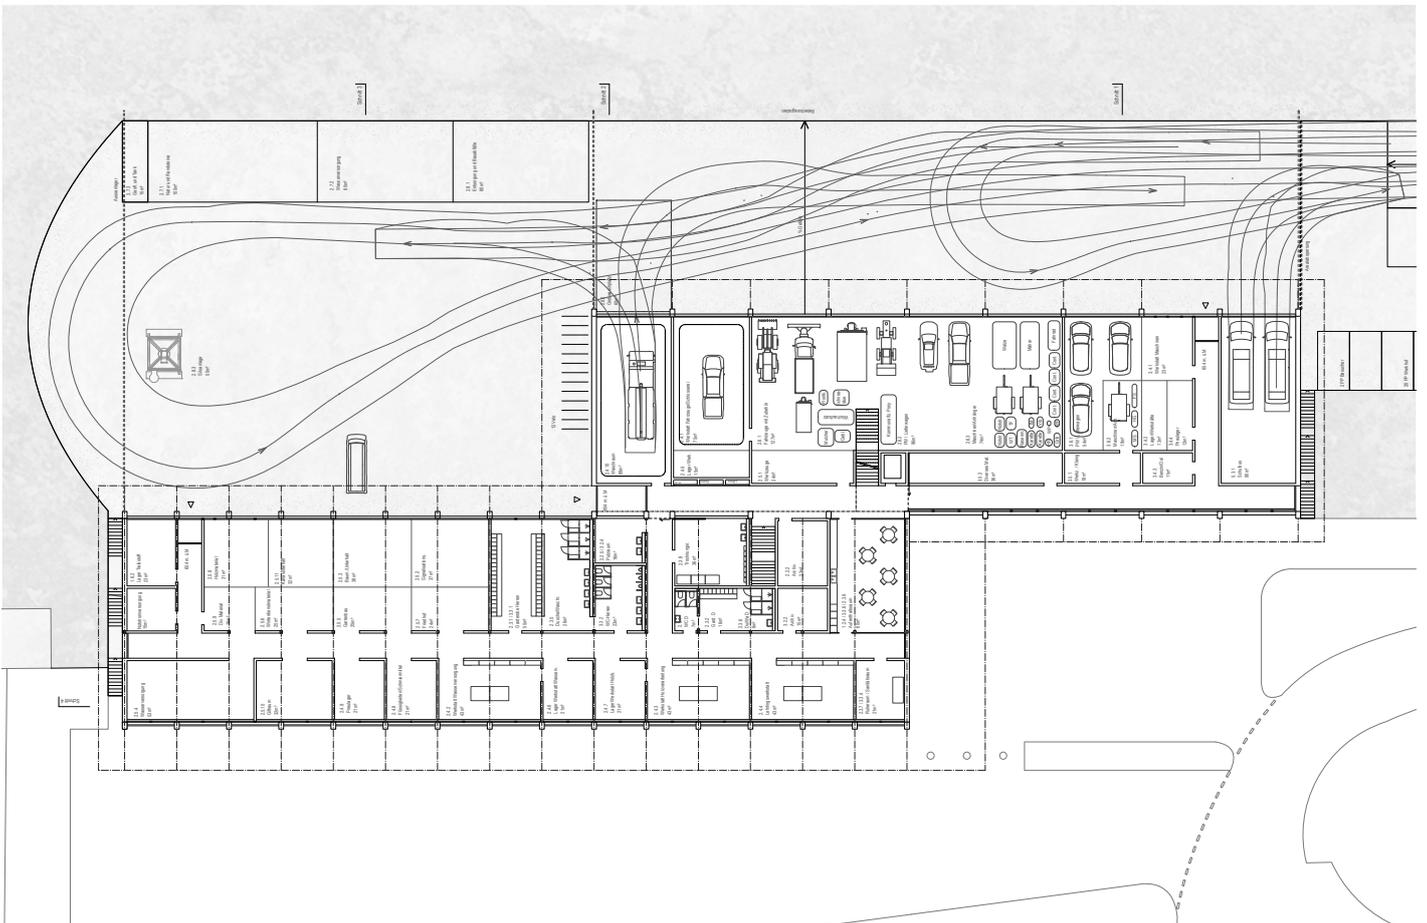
Grundriss obere Ebene Siegerprojekt
